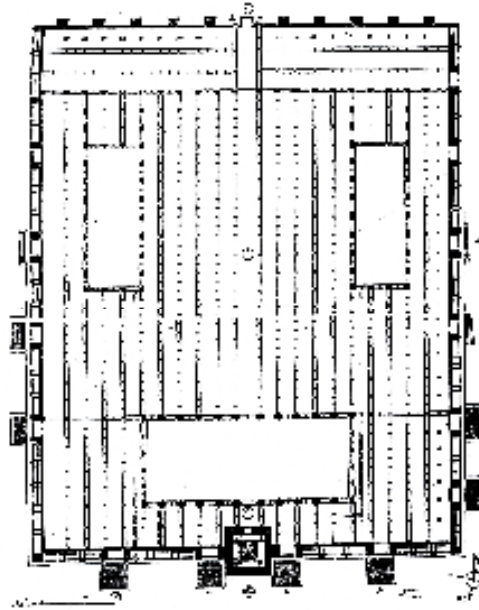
مسقط أفقي لجامع الكتبية الأول بمراكش.
